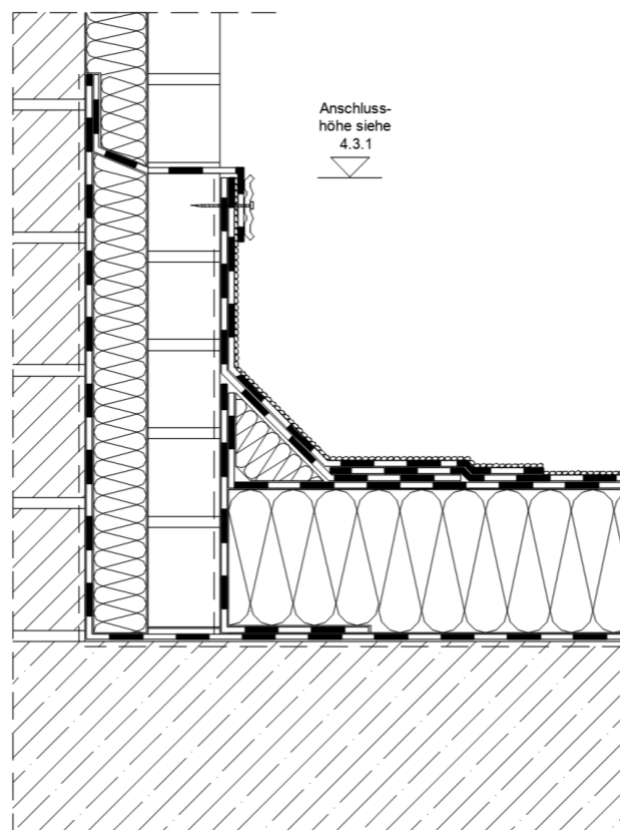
Starrer Wandanschluss mit Kunststoffbahnen und Verbundblech – ungedämmte Wand
